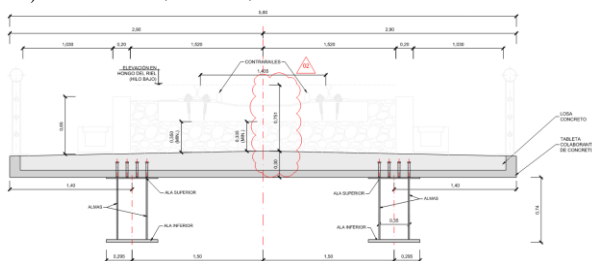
Sección transversal del tablero de vigas cajón gemelas
